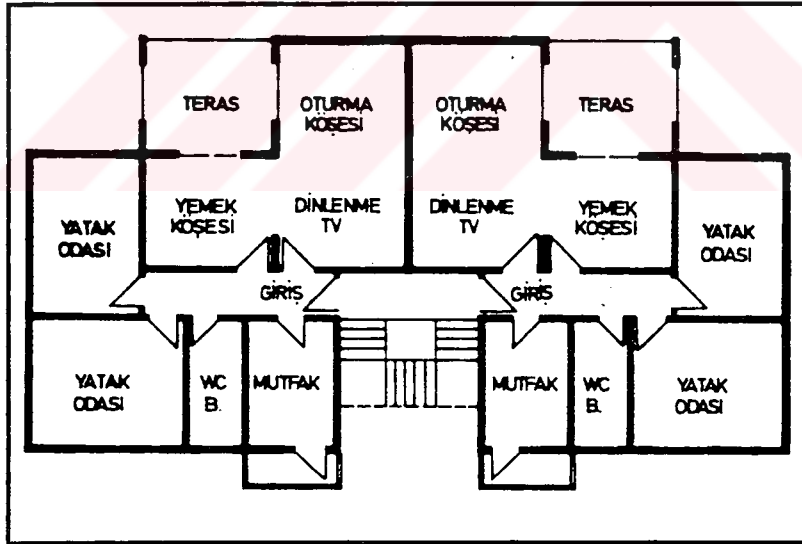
Prefabrike İskelet Sistemle Örnek Kat Planı Tasarımı
